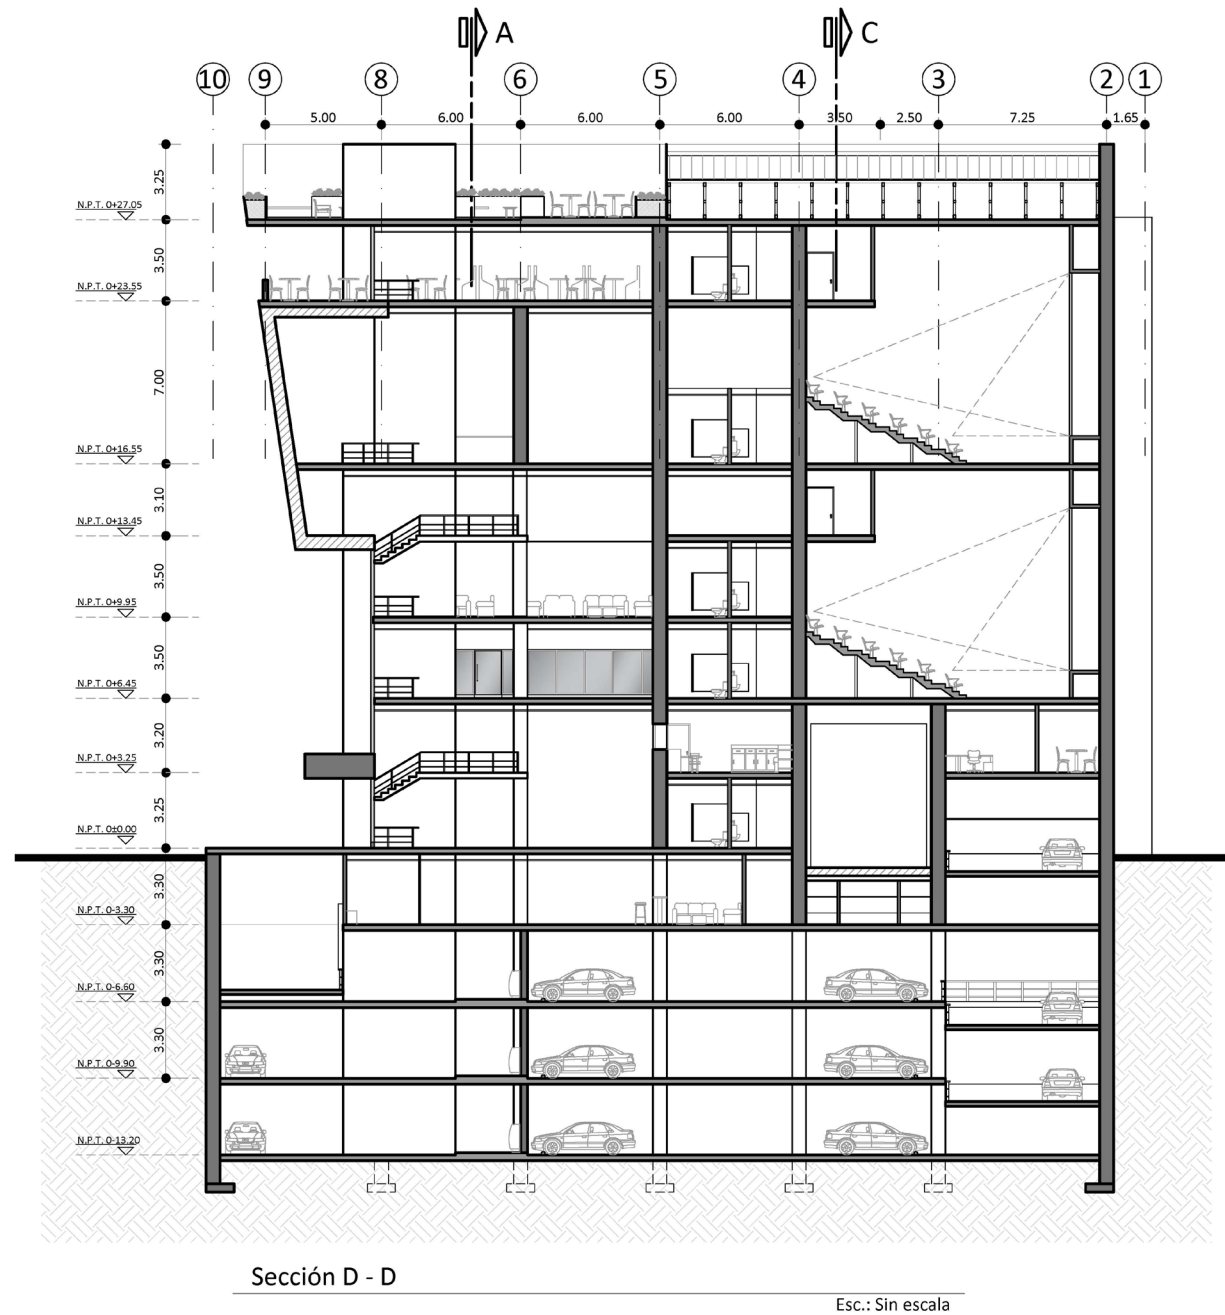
Sección arquitectónica D - D. Fuente: Propia.
